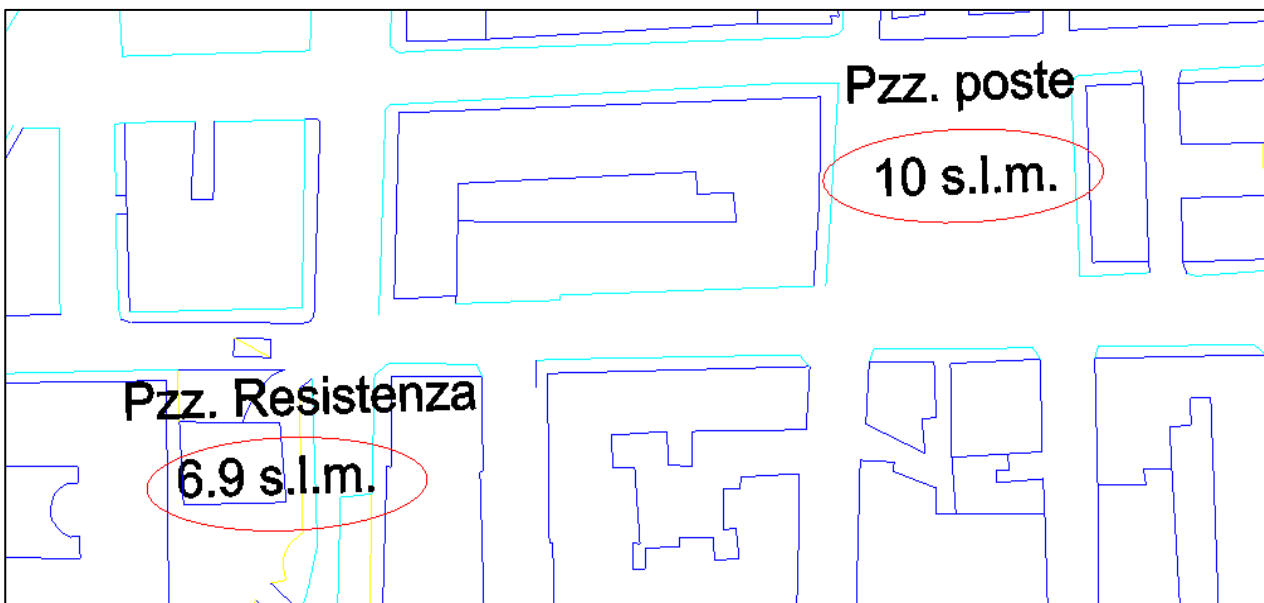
Planimetria Piazza delle Poste con indicazioni quote slm
